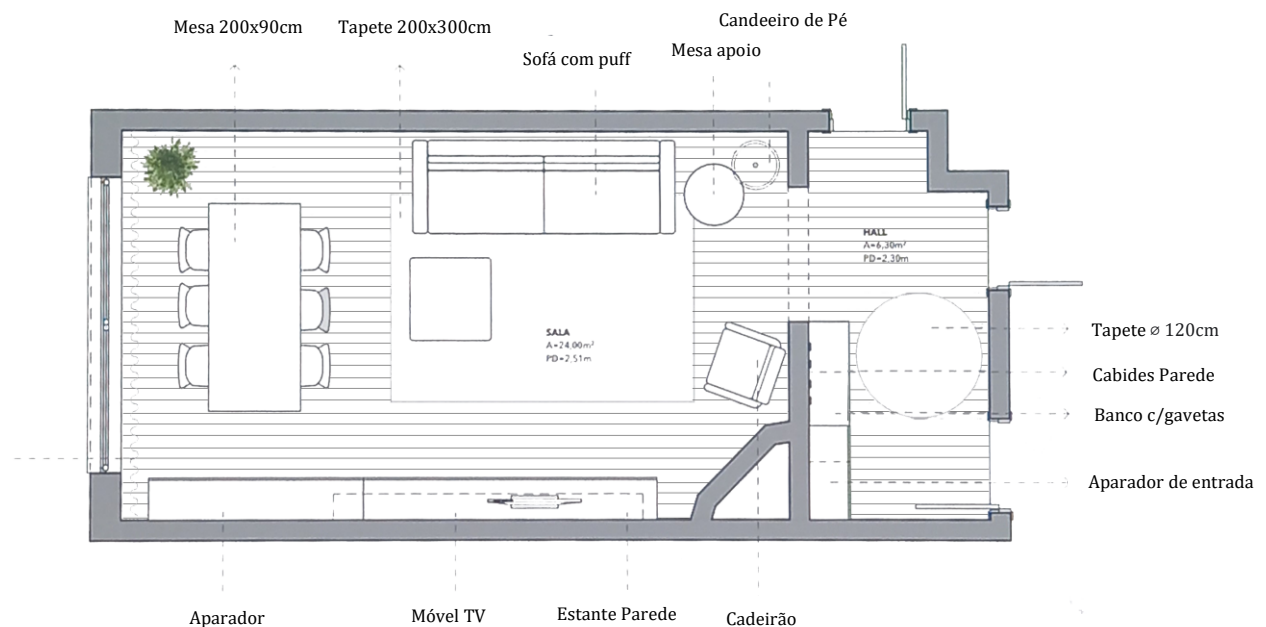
Proposta Planta Decoração. Fonte: Homestories
